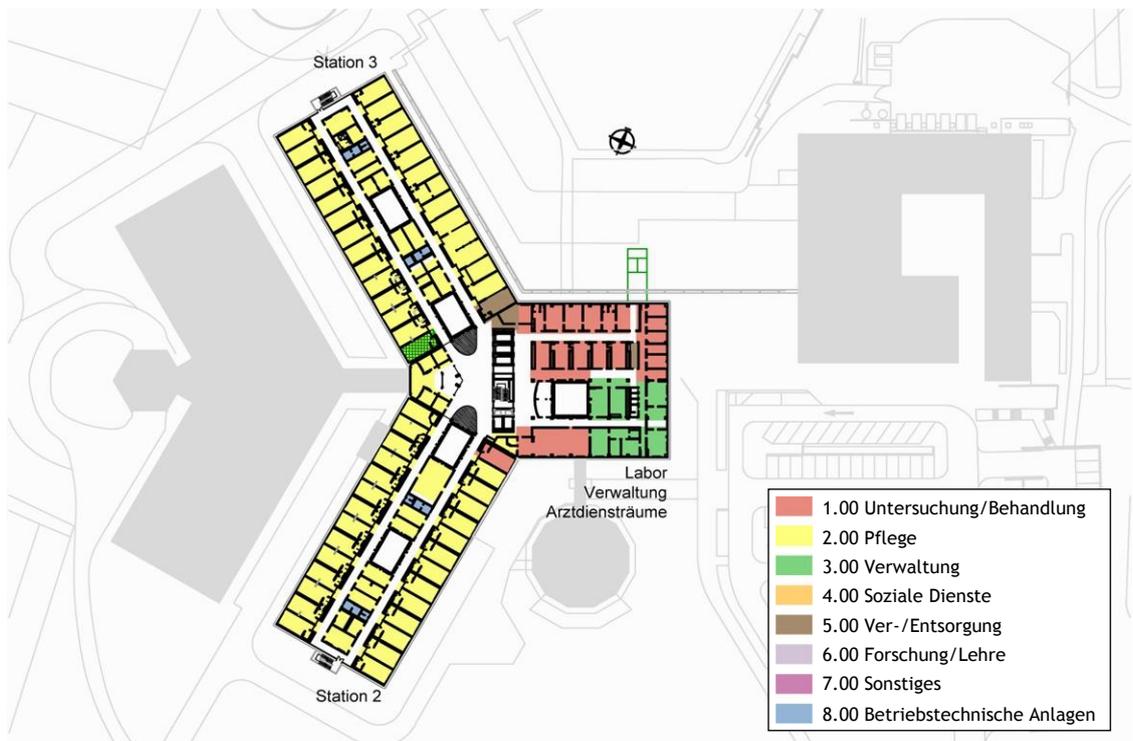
SOLL-Flächen nach DIN 13080 - 2.Obergeschoss
